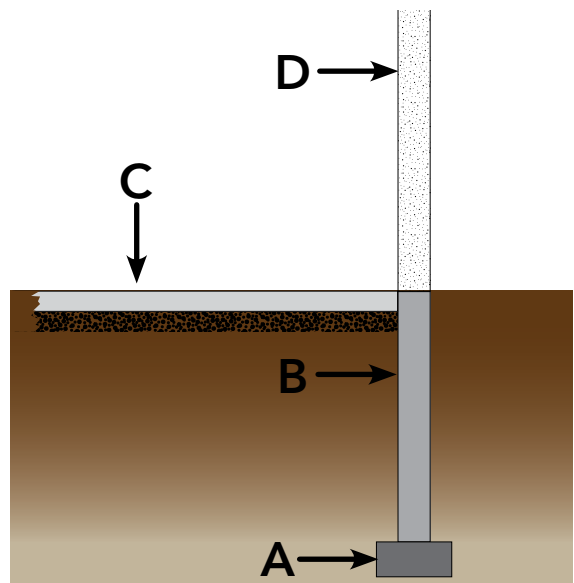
Ilustración de una (A) zapata, (B) muro de fundación, (C) losa, y (D) pared.
